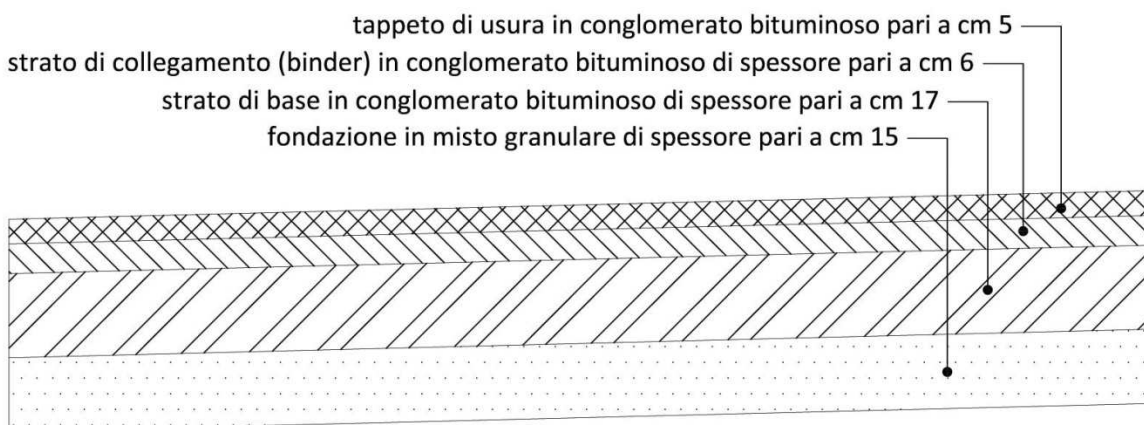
Particolare della pavimentazione delle rampe 1, 2 e 3
